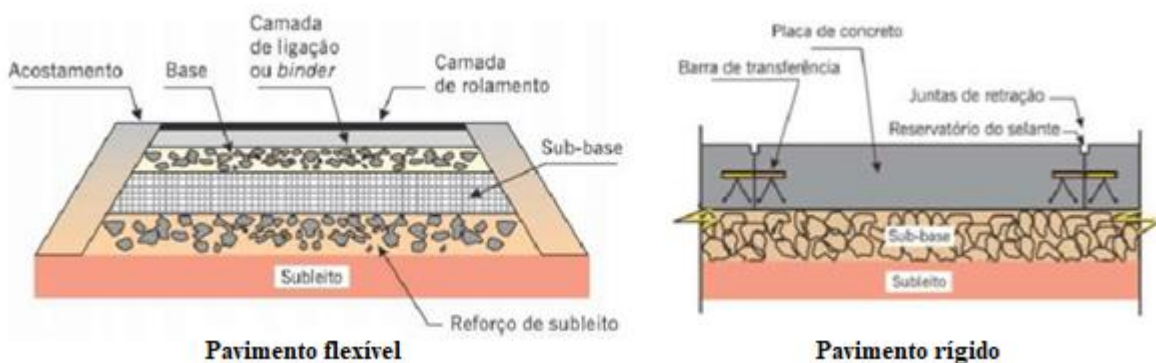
Estrutura dos pavimentos (Fonte: Pavimentos rígidos em rodovias, 2014).
